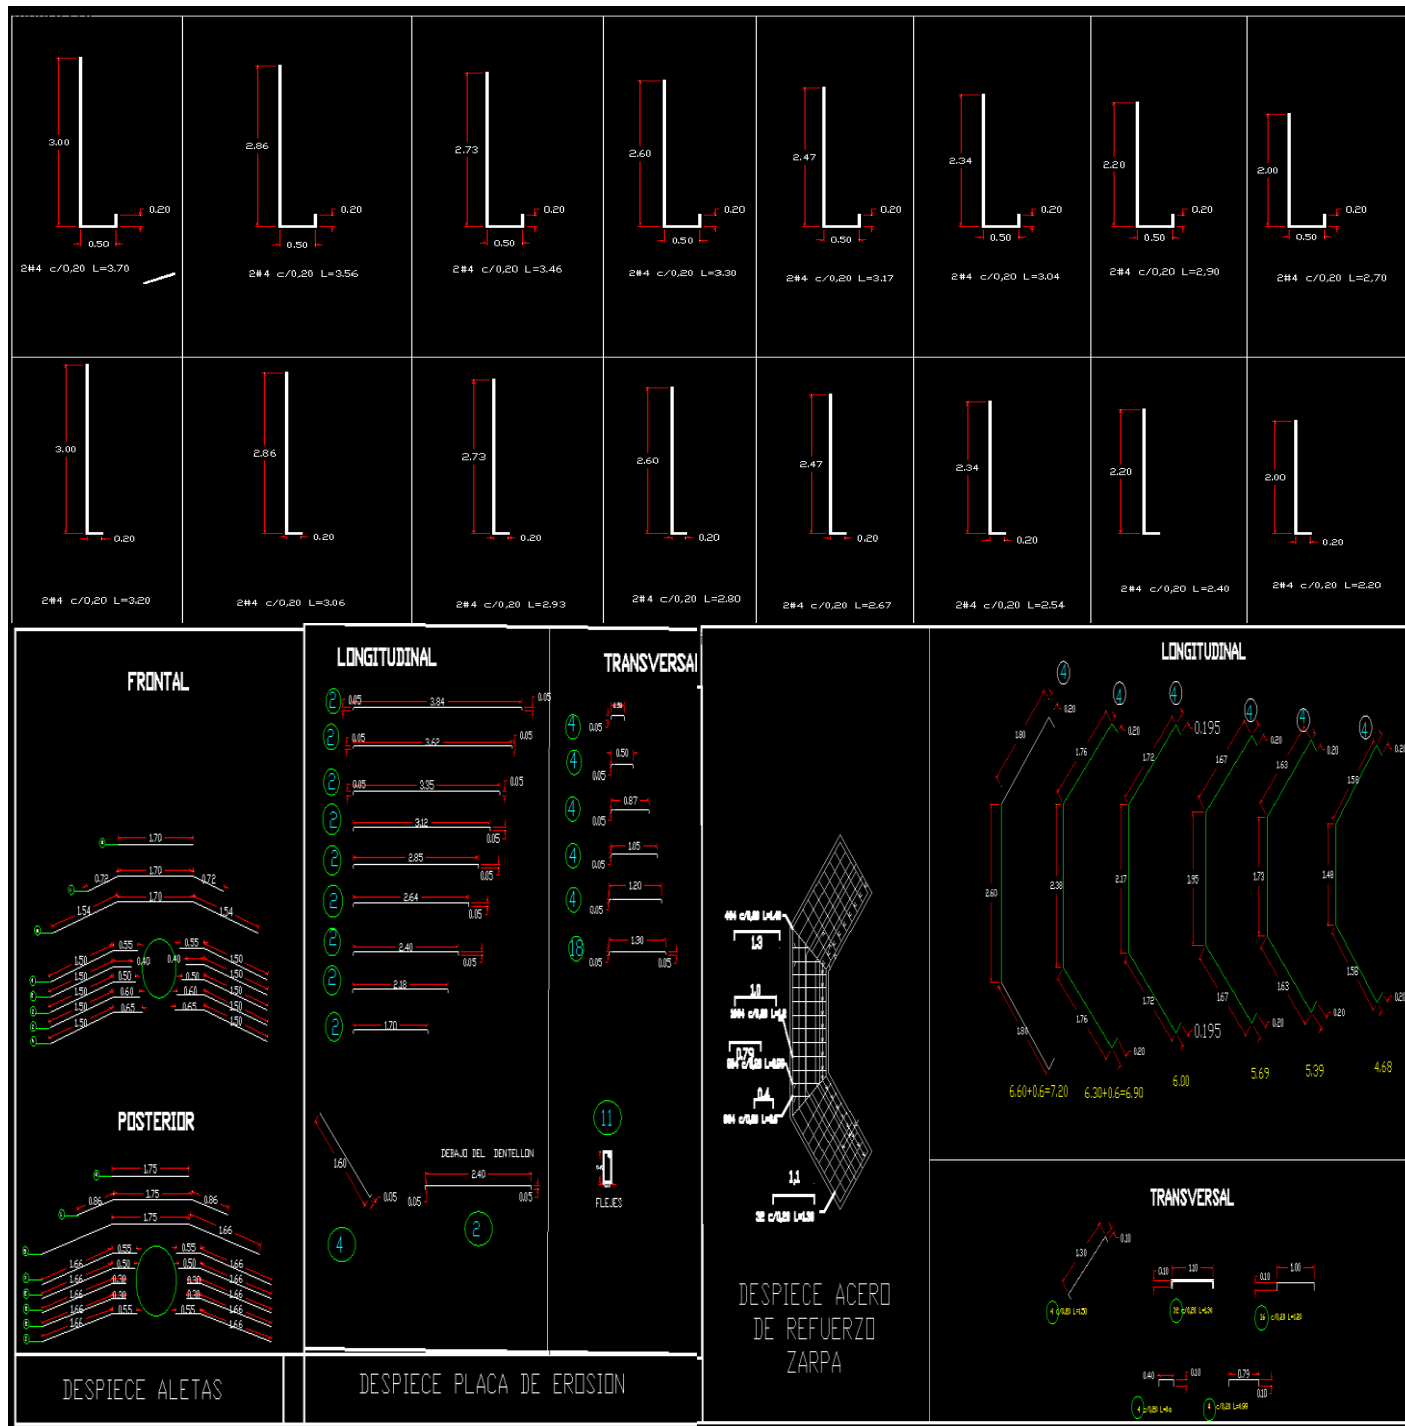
Despiece del acero de refuerzo. Fuente: AutoCAD
